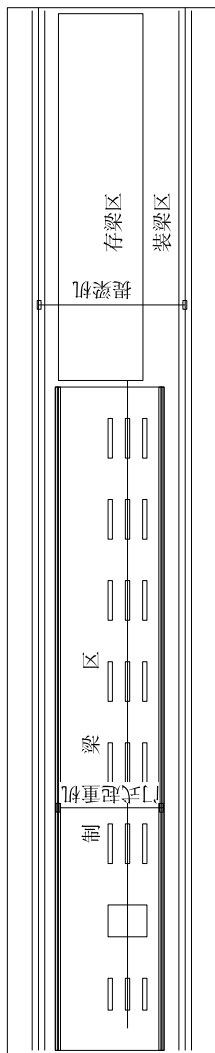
提梁机搬梁、轮轨运梁车出梁平面布置图
